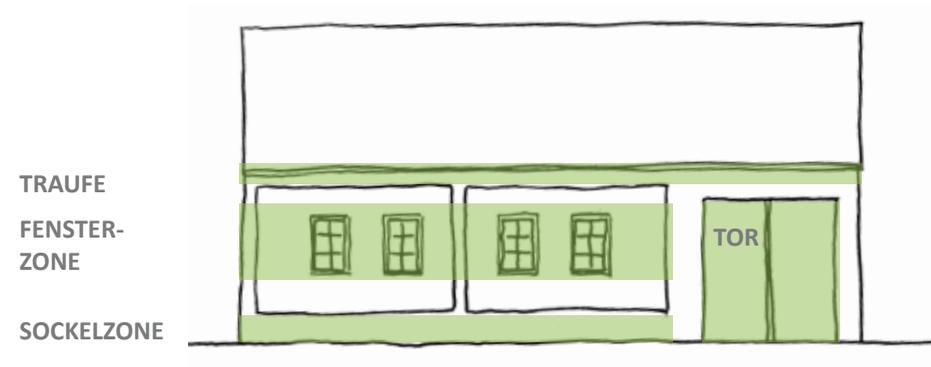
Skizze Fassadengliederung Breitfassadenhaus
